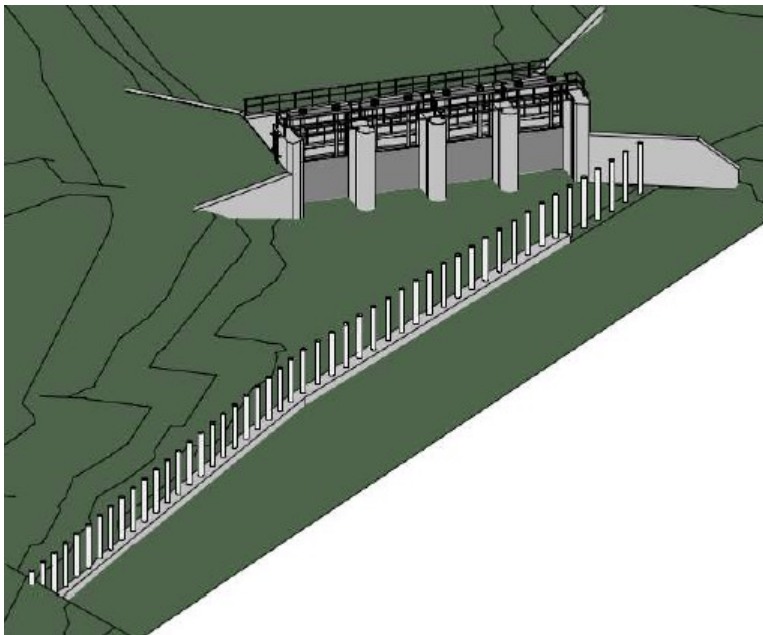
Geplantes Dotationsbauwerk mit Einlaufrechen ([13], Kap.7.5.1, Abb.32)
